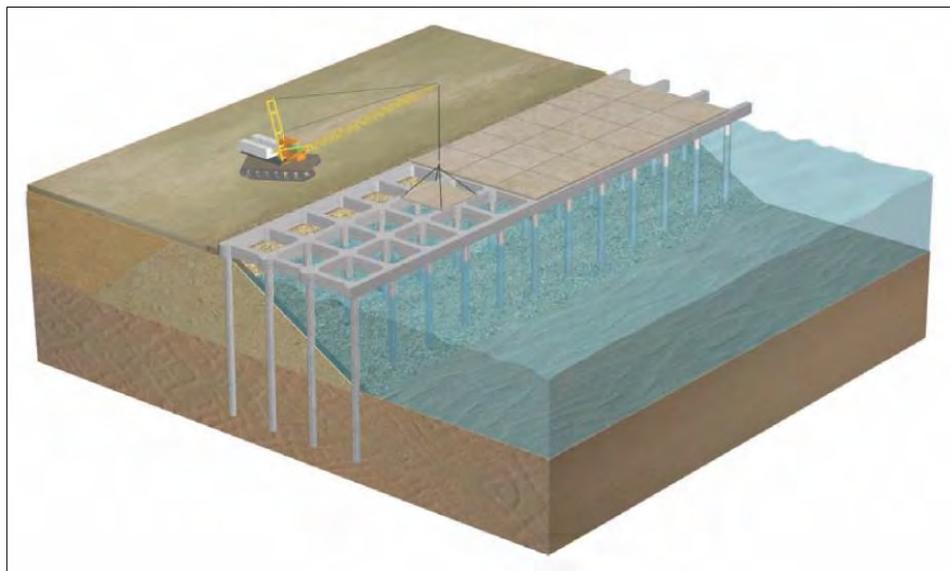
Ejemplo de la instalación de losas prefabricadas de concreto
